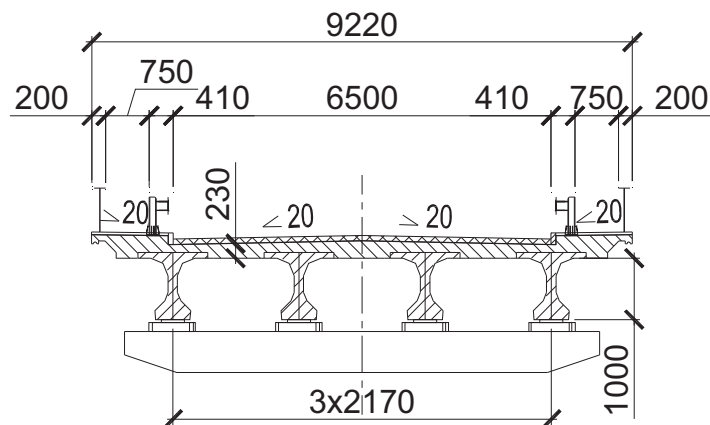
Поперечний переріз шляхопроводу на км 256+480
